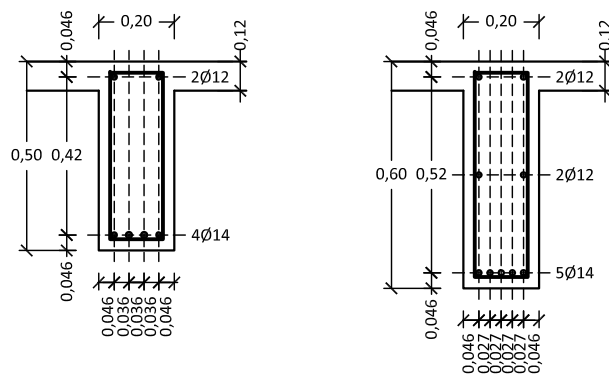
Pormenorização das armaduras das vigas. Escala 1:20
